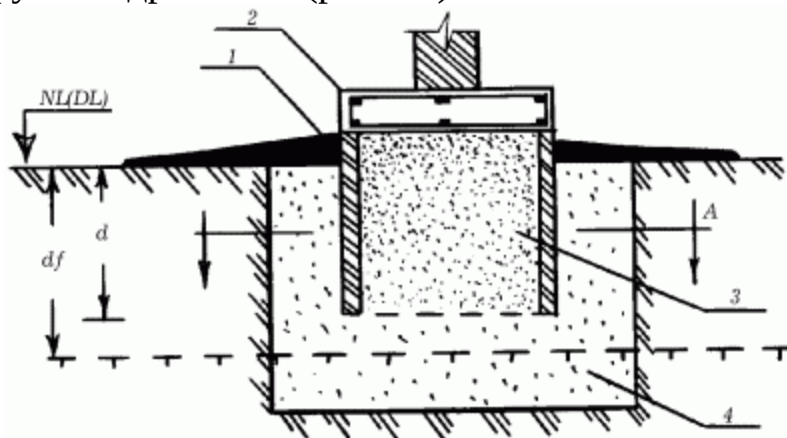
Устройство малозаглубленного фундамента в виде открытой оболочки: 1 – оболочка; 2 – опорная подушка; 3 – грунт-дренаж; 4 – песчаная подушка.
